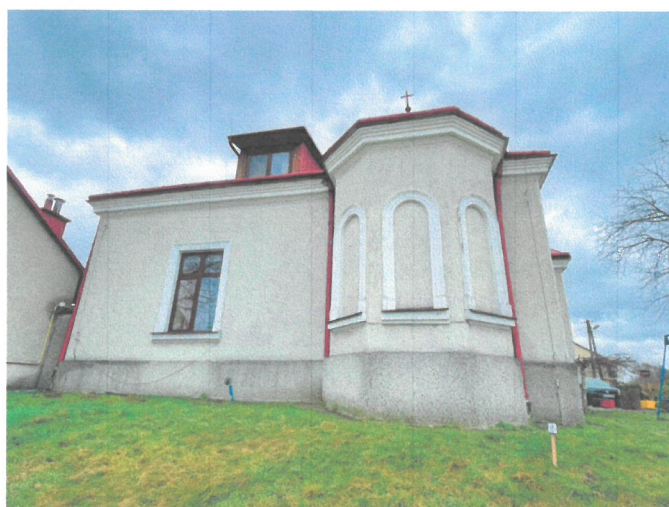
Elewacja południowa – mur wzdłuż pomieszczenia kaplicy. Widoczna degradacja i spękanie tynku w poziomie cokolu, zdegradowana opaska betonowa.
